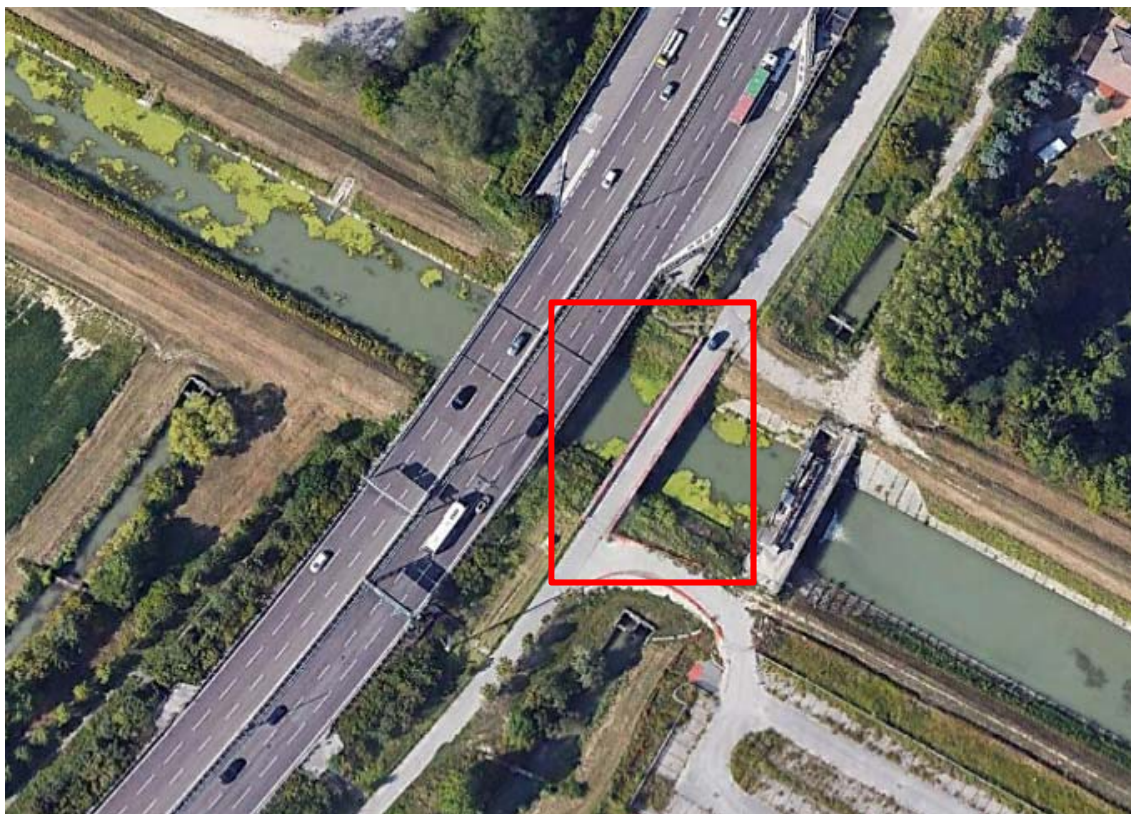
Vista planimetrica della zona oggetto di intervento
